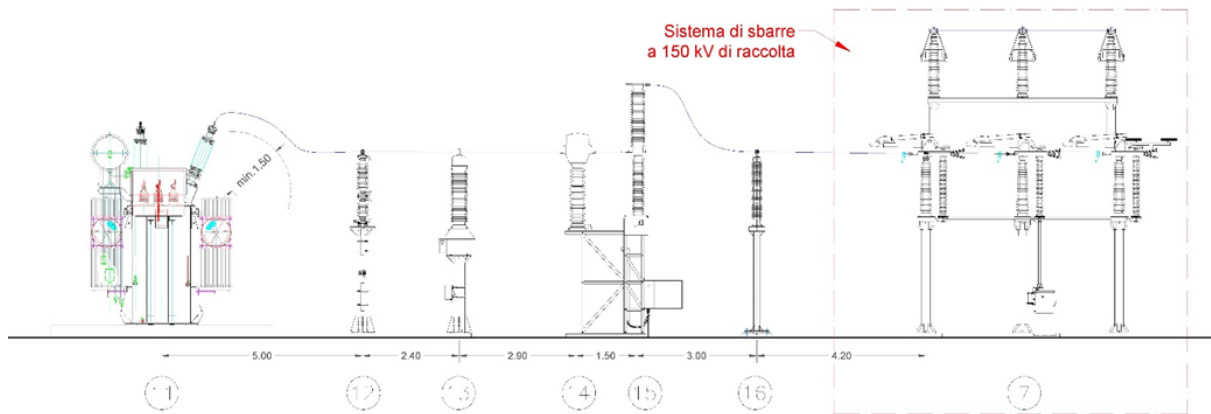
Sezione B-B' - Stallo di elevazione AT/MT
